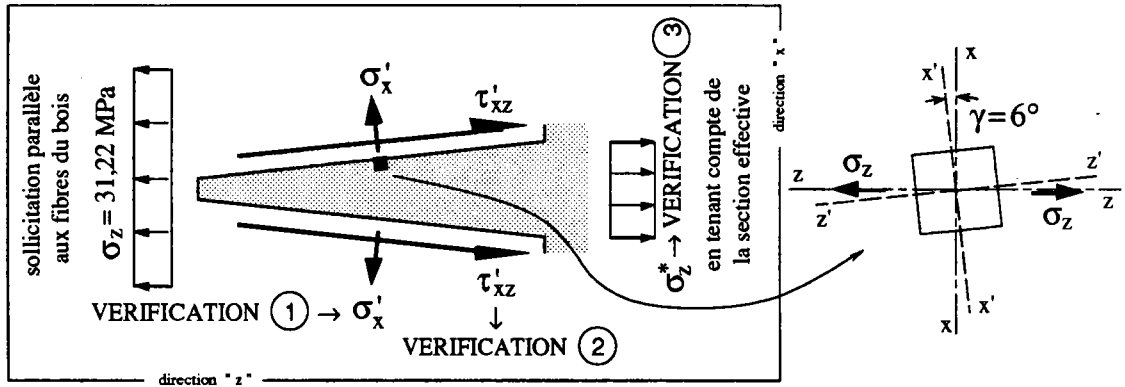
Section suivant un plan parallèle aux fibres du bois de la pièce de coin en contenant la section longitudinale des entures.
